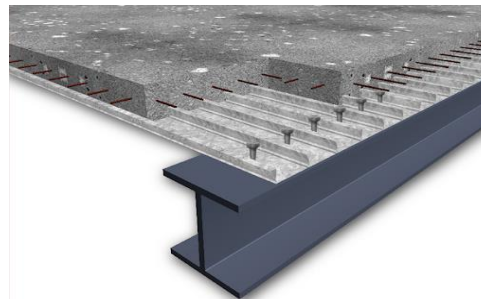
Приклад влаштування перекриття з сталезалізобетонних конструкцій
